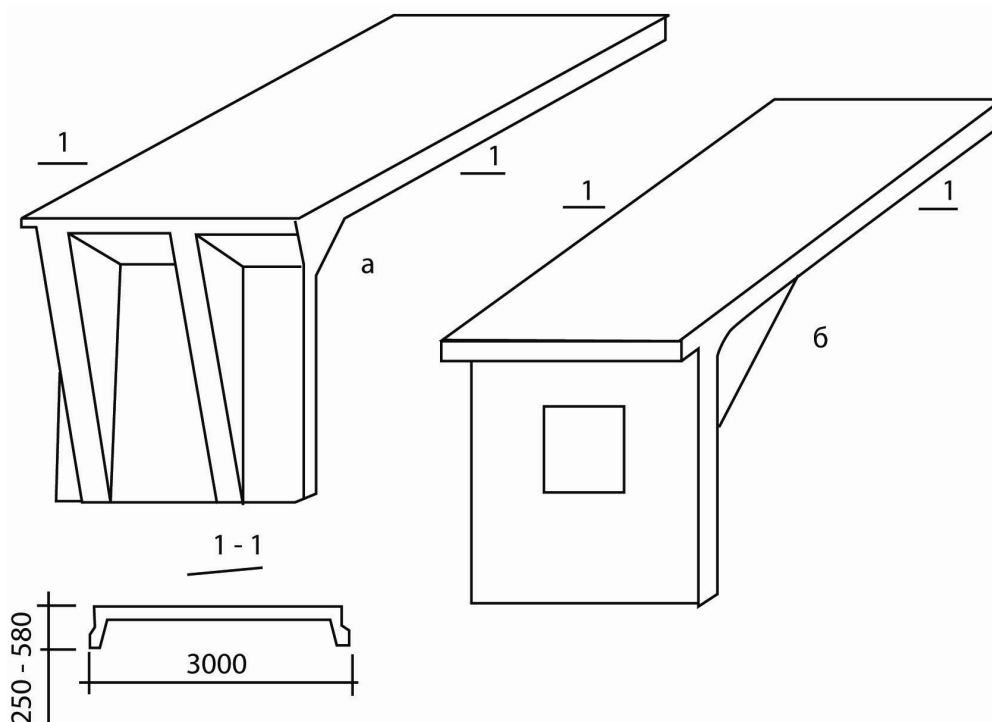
Рамно-панельна конструкція елементів споруди з прольотом: а – 12 м; б – 18 м
